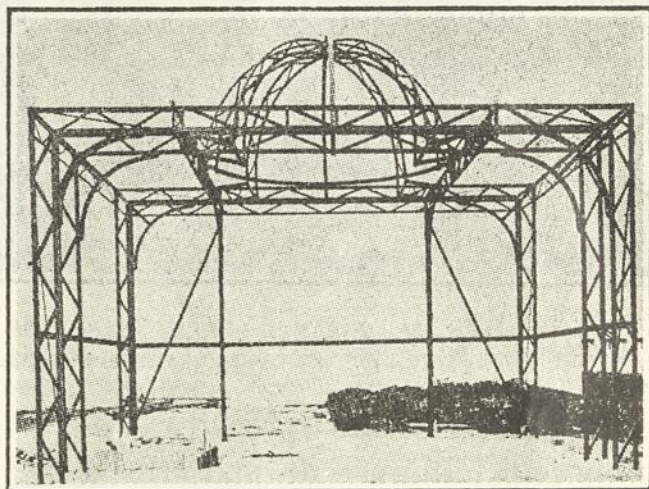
Carcasse de pavillon, entièrement soudée.
